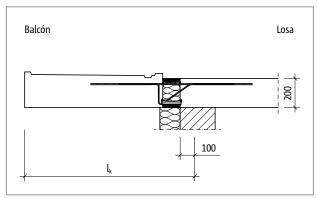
Schöck Isokorb® XT tipo K: Plano
